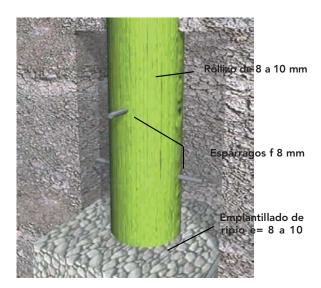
45 : Emplantillado de ripio para los pilotes de madera impregnados, espárragos para la adherencia con el hormigón.
